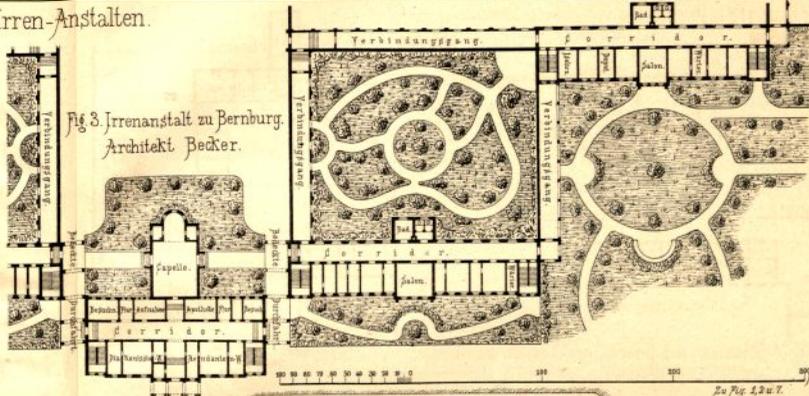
Irrenanstalt zu Bernburg. Architekt. Becker.
